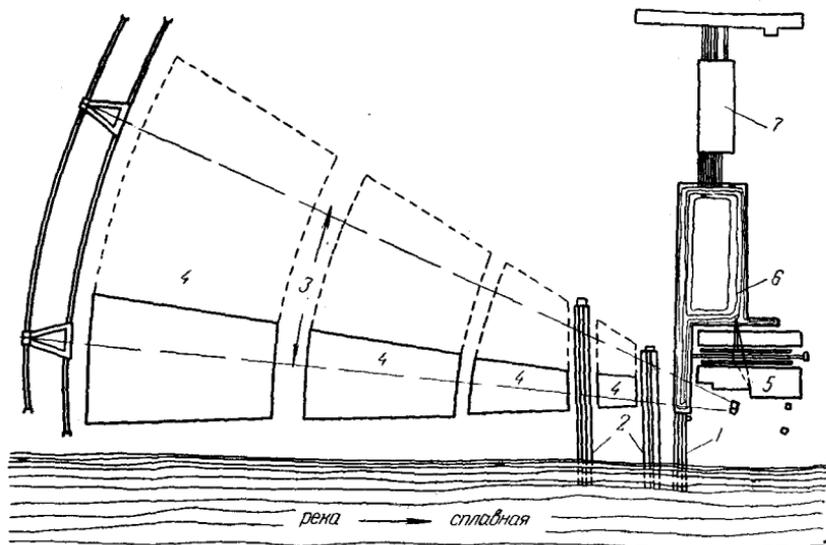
Схема склада бревен, оборудованного радиальными кабельными кранами и бремсбергами:
